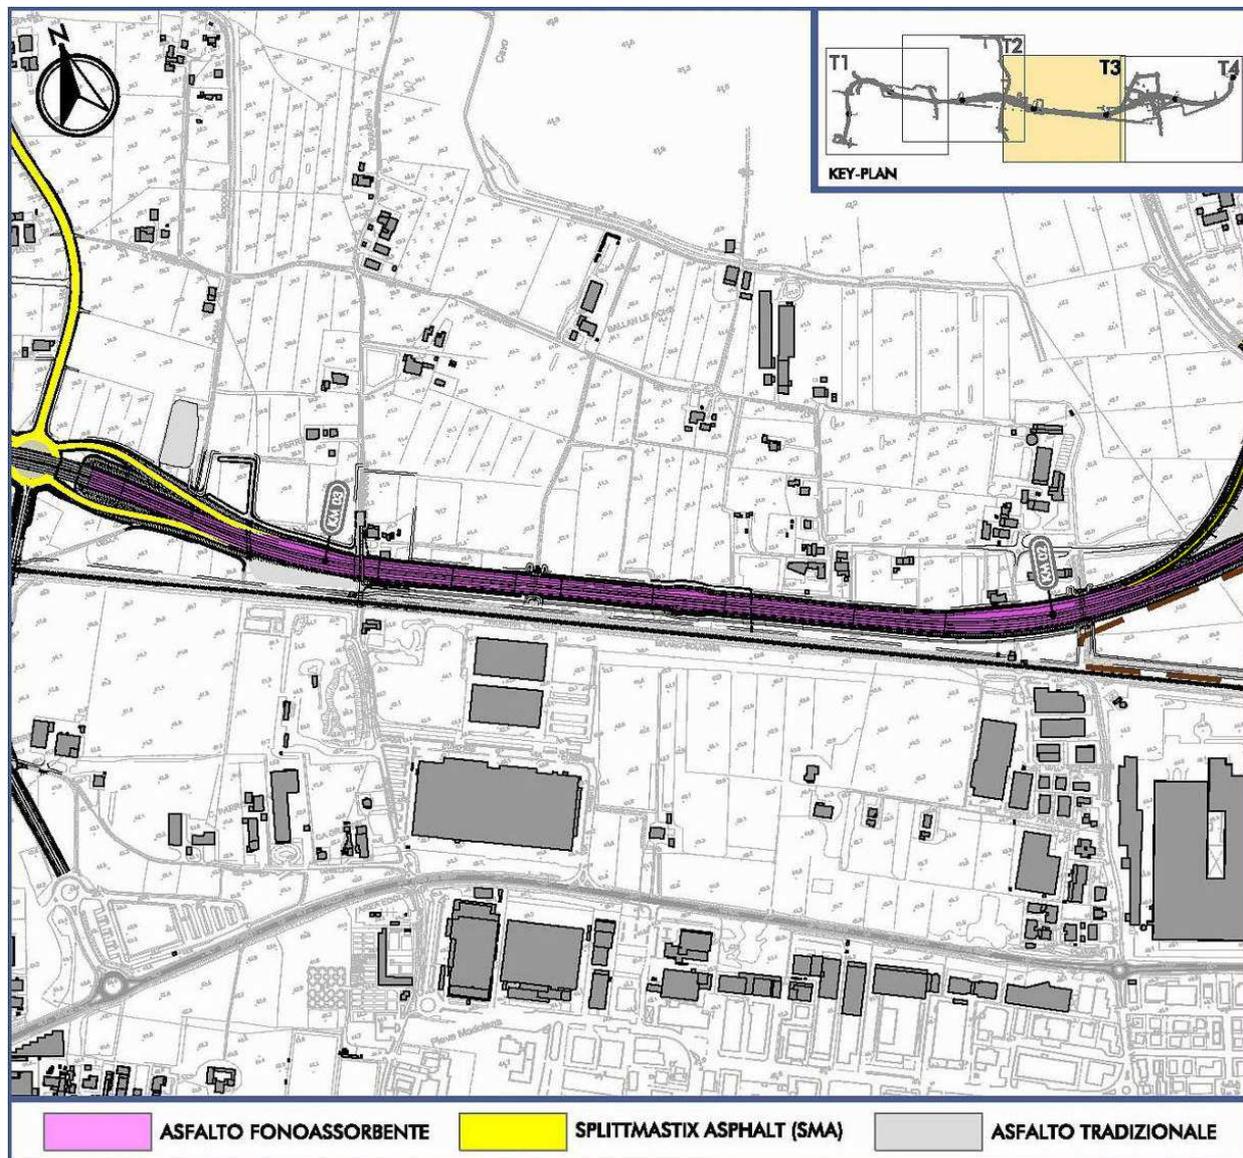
PAVIMENTAZIONI STRADALI DI PROGETTO NEL TRATTO TRA LE PK 1+800 E 3+400
